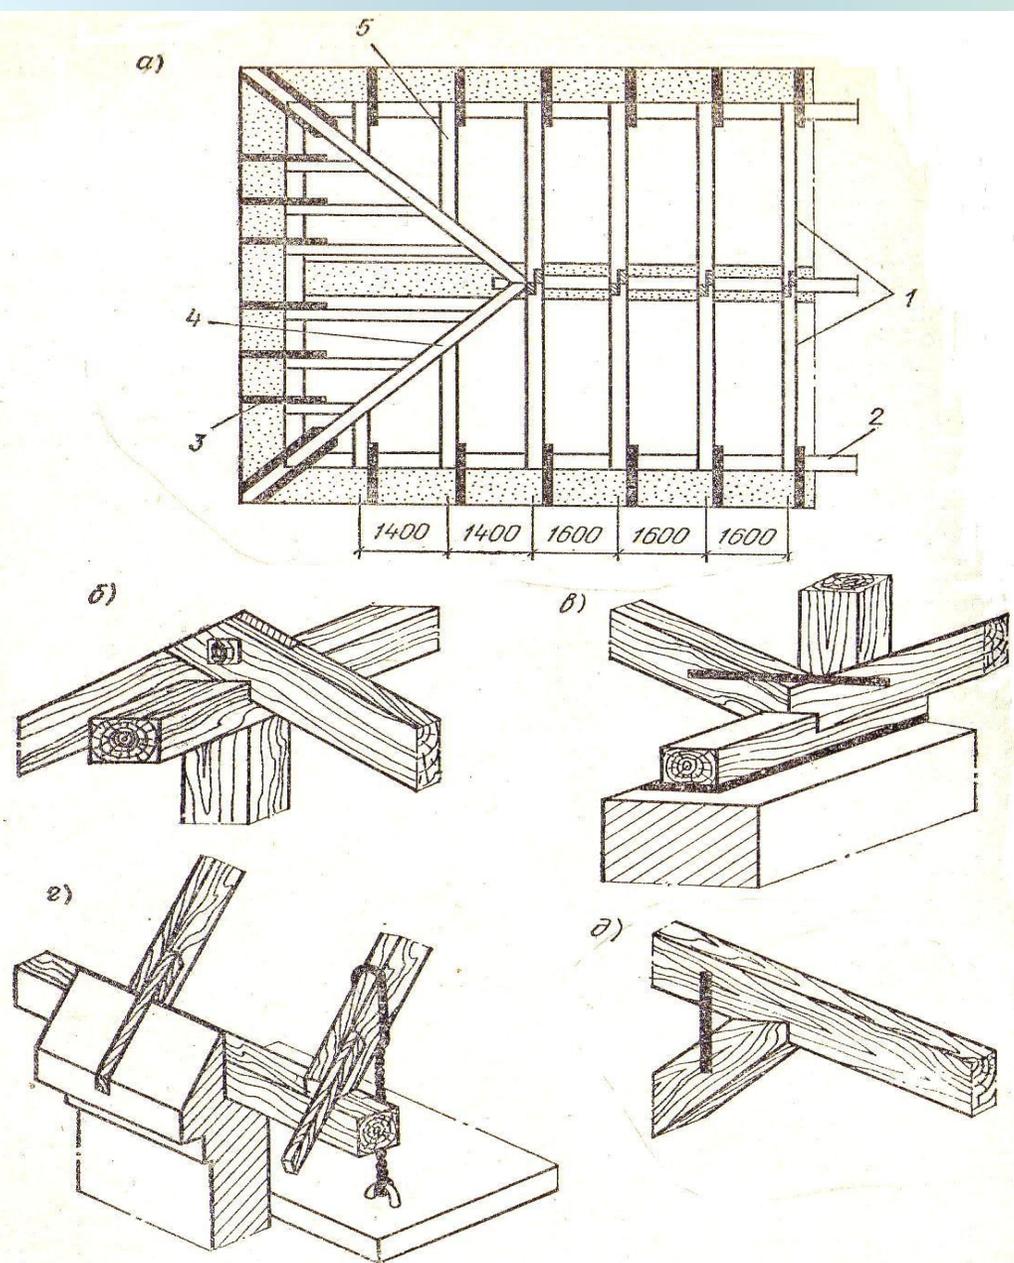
Фрагмент плана крыши и узлы наслонных стропил
